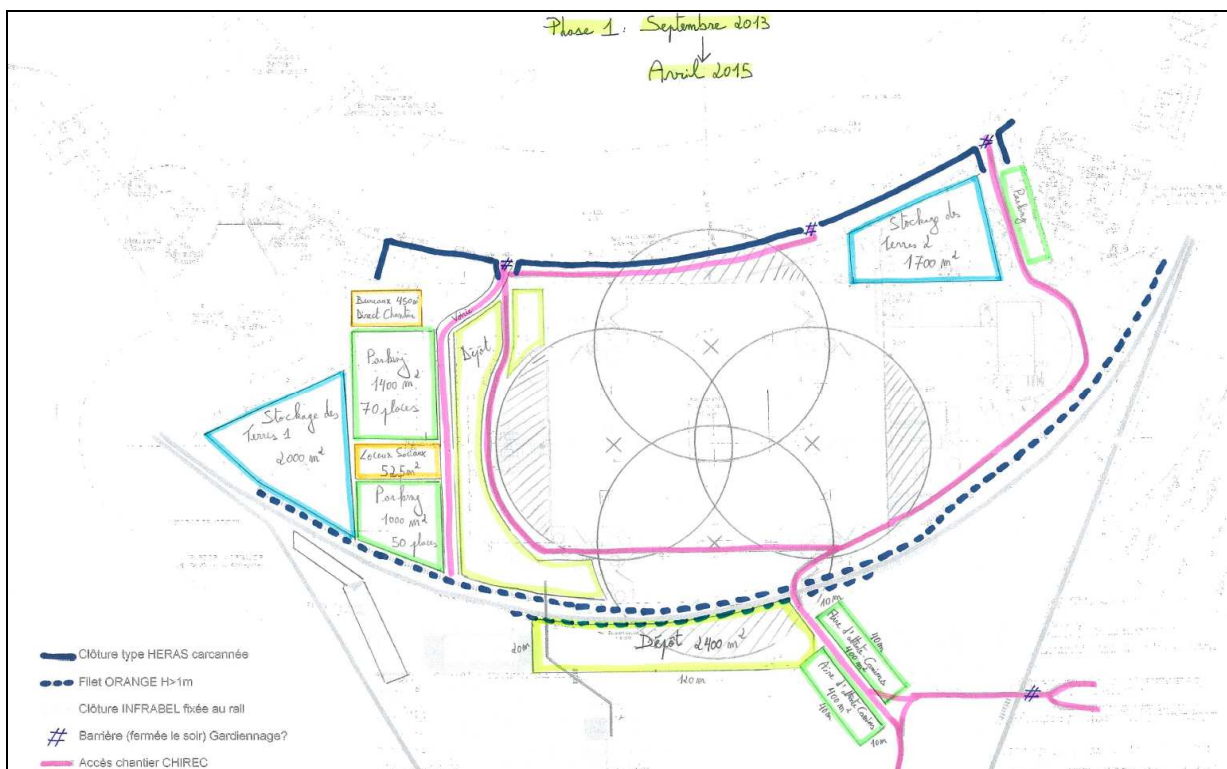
Plan provisoire d'installation de chantier de l'hôpital - phase 1 (Source: ASSAR)
